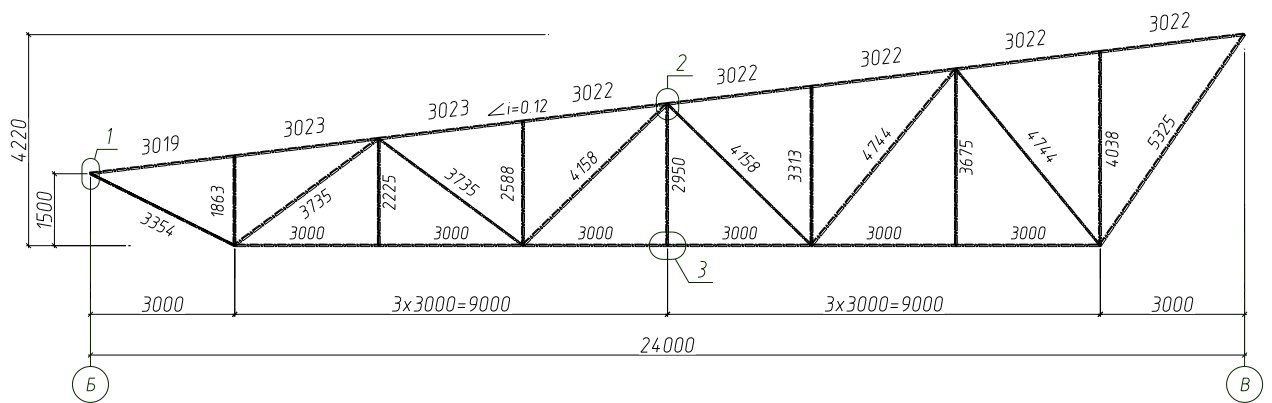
Схема к расчету и конструированию узлов фермы
